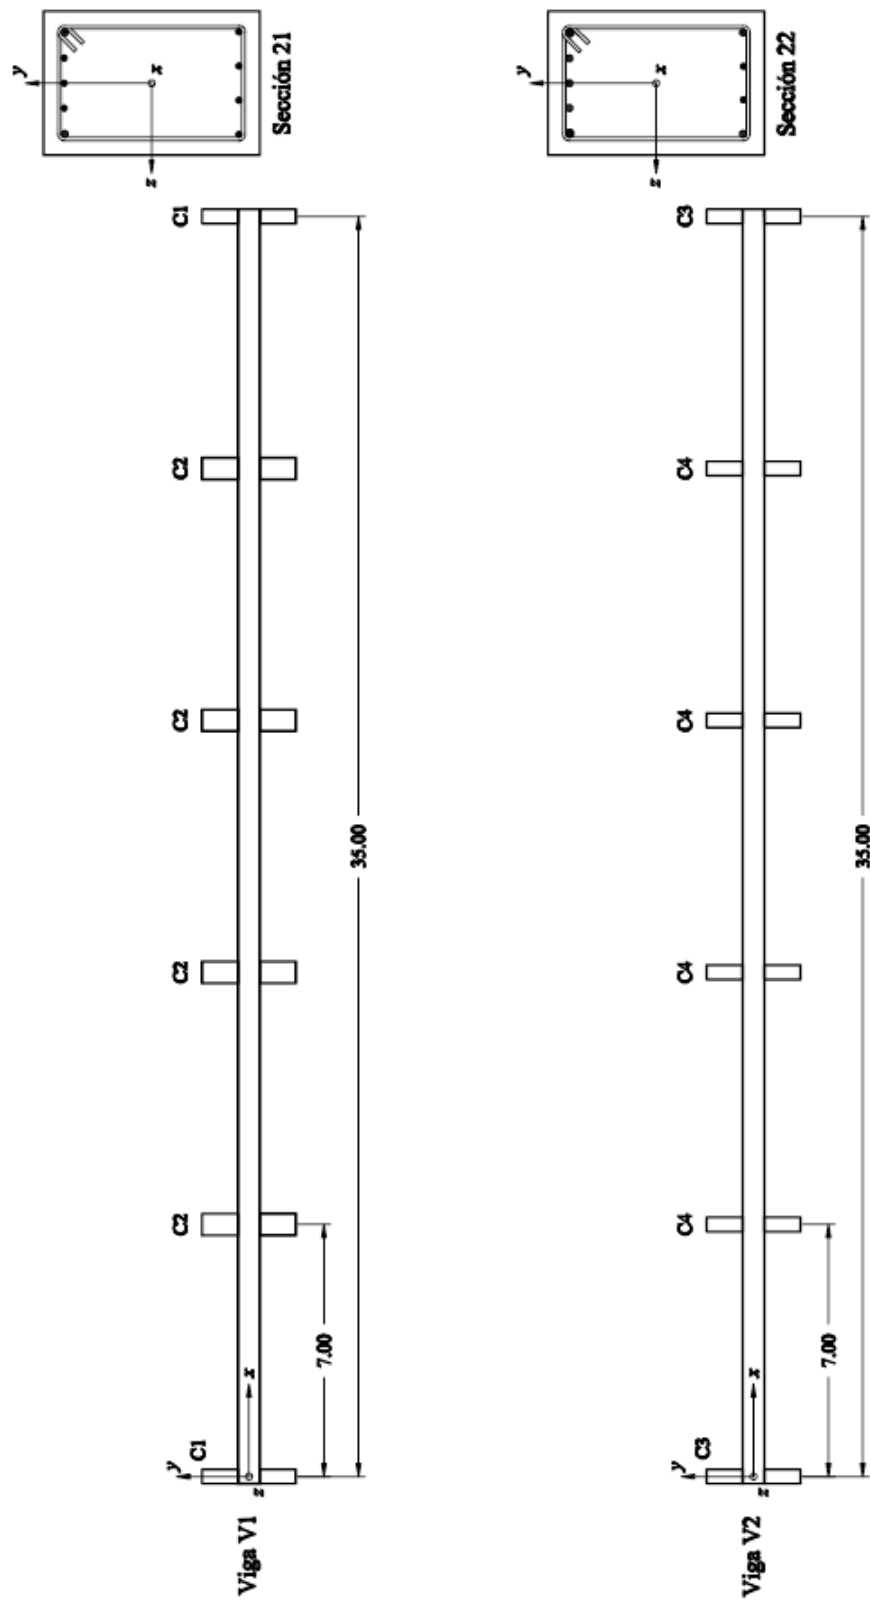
Vigas V1 y V2. Vista de Elevación (Unidades en m)
